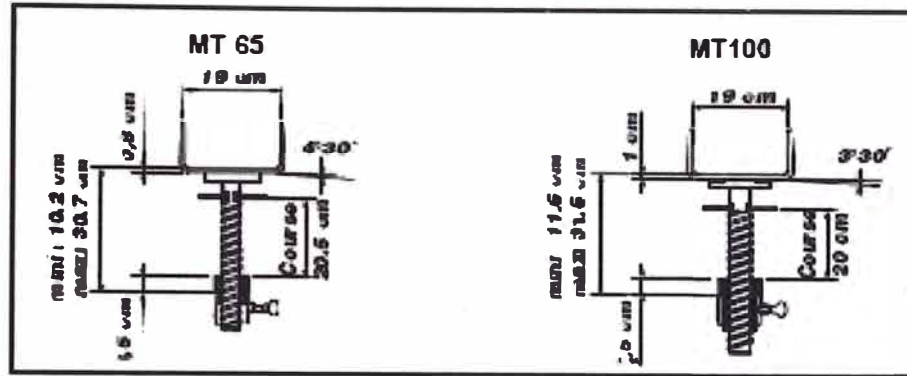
Pistón Hidráulico de cabeza de torres MILLS
